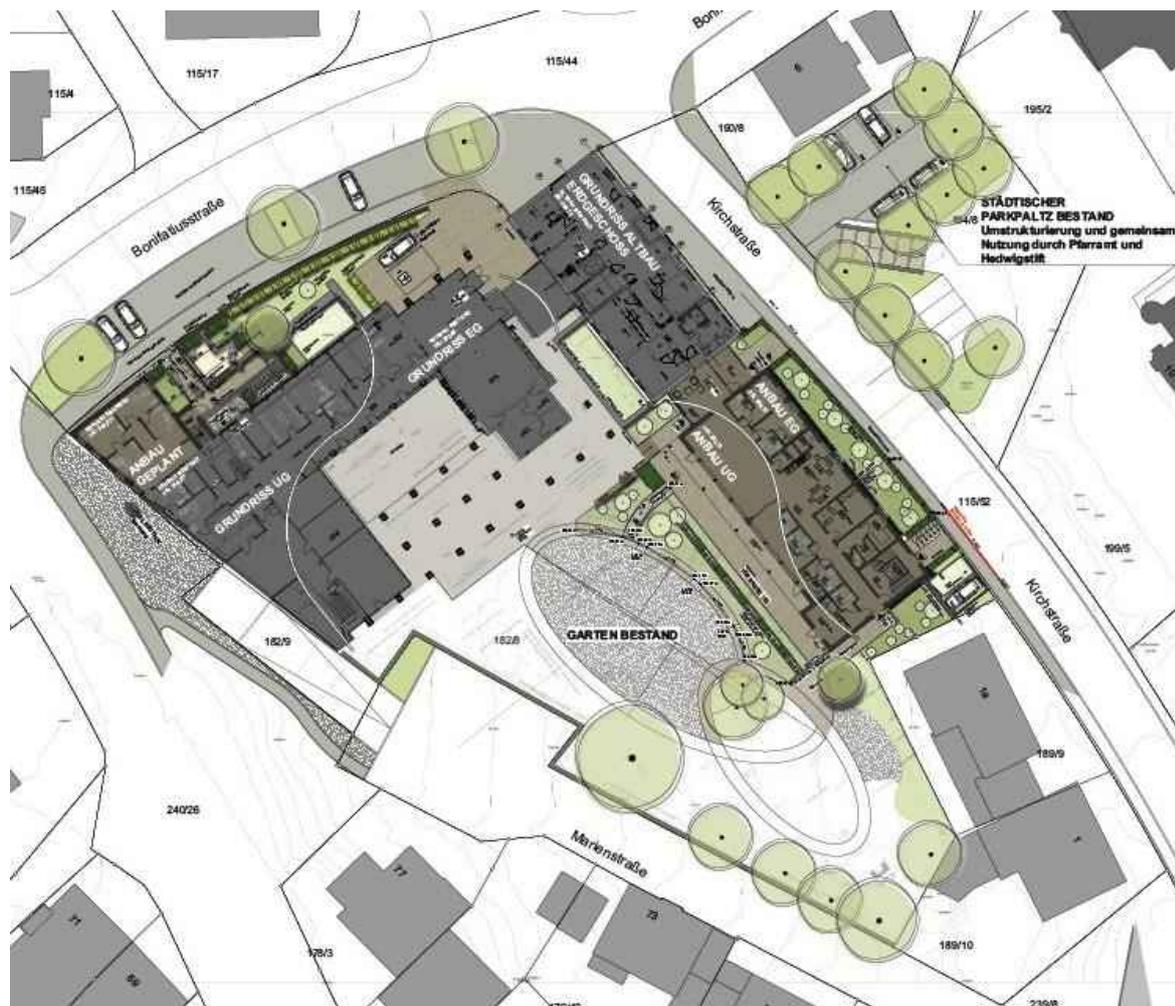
Lageplan des Entwurfs zur Erweiterung des Hedwigstifts
